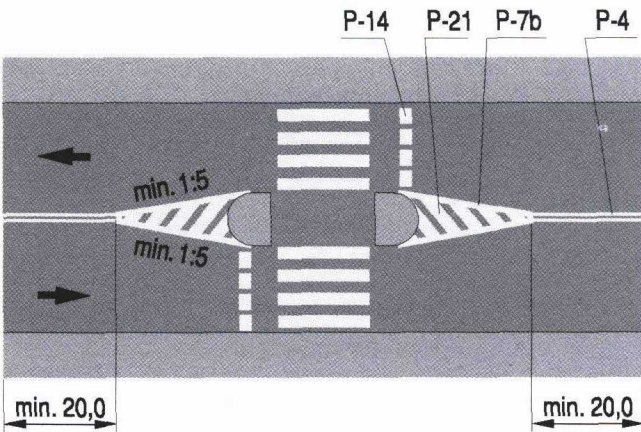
Sposób wyznaczenia poszerzonego przejścia dla pieszych przy przystanku tramwajowym
